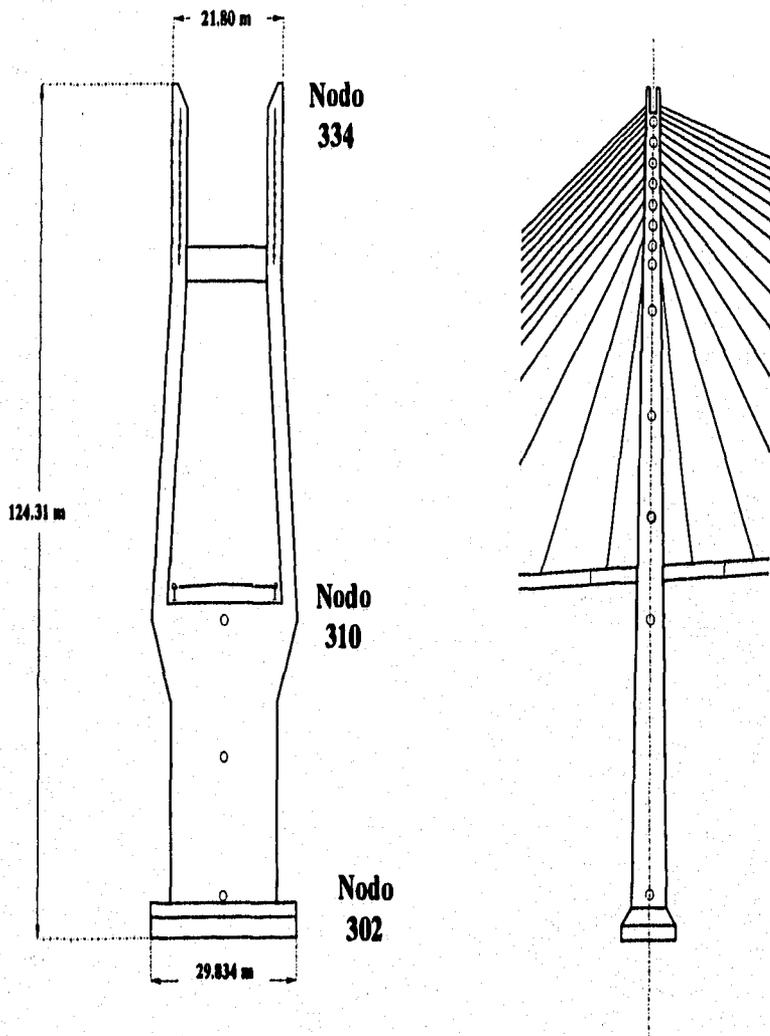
Colocación de puntos de control sobre el pilón del puente Barranca el Zapote
